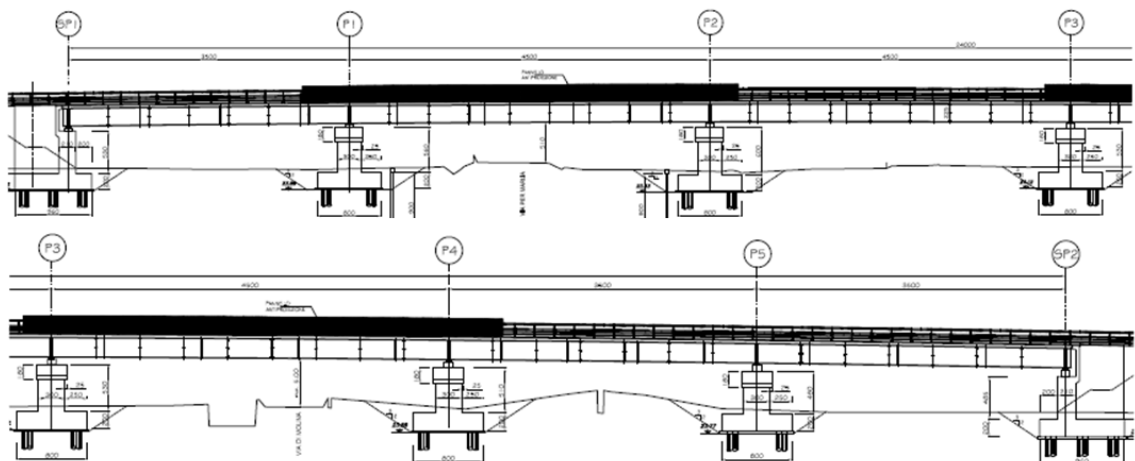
Viadotto dell'Acqua Calda: profilo longitudinale
